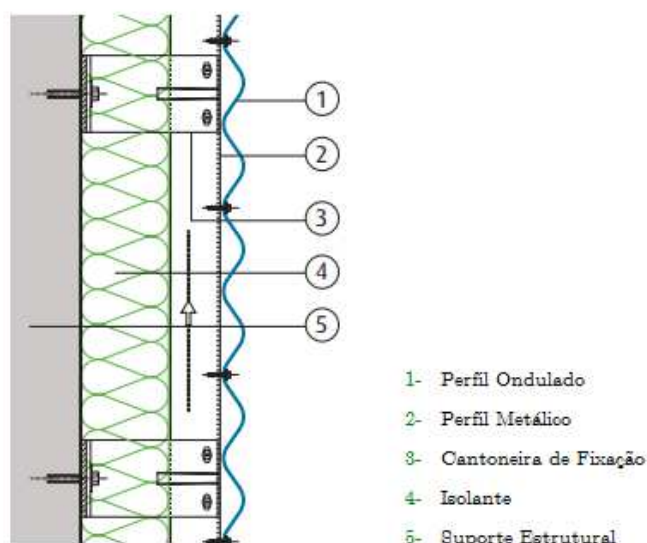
Esquema construtivo do sistema perfil ondulado [6]
